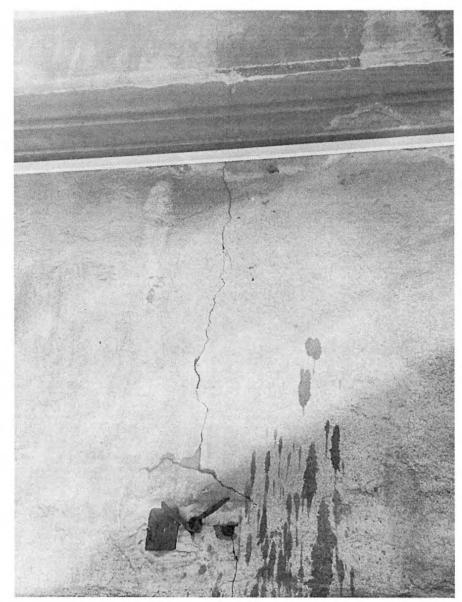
Fisuras en muros en fachada norte, patio interior.
